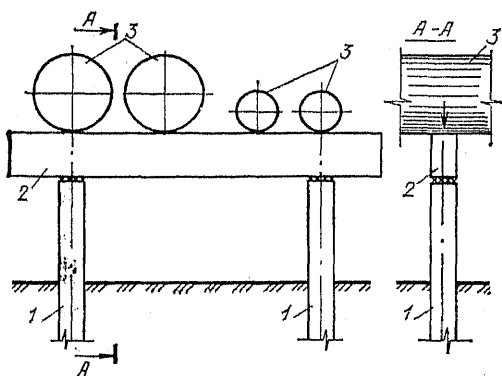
Бескотлованная конструкция свайного фундамента под опоры трубопроводов
